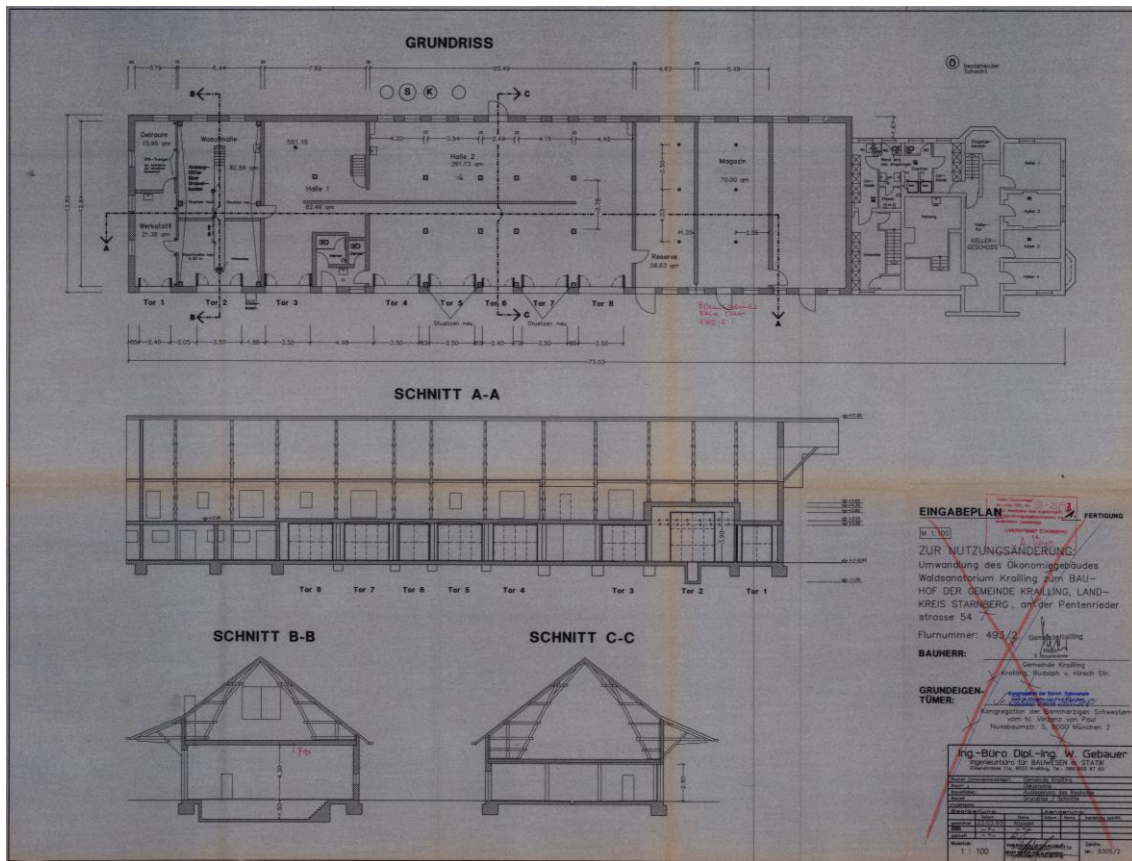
Grundriss und Schnitte zu den Um- und Ausbaumaßnahmen, (Genehmigungsbescheid 24.08.1993)
